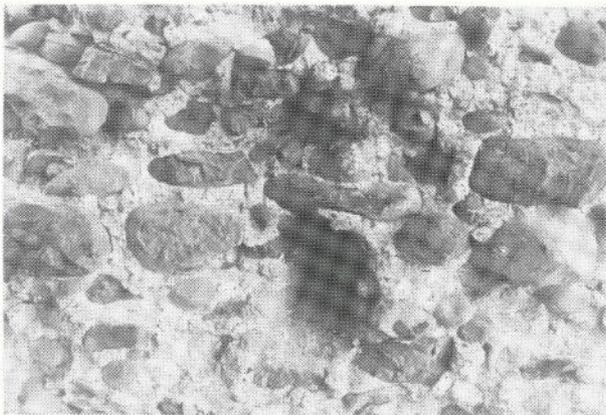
Rampa scalare: particolare del foro a sezione rettangolare.
